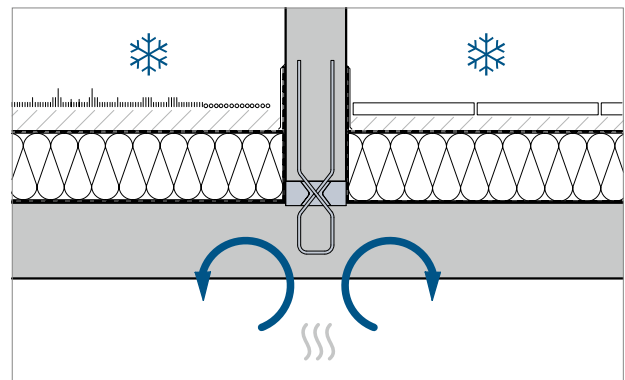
Pos ②: Warmtestroom externe kolom met flankisolatie
